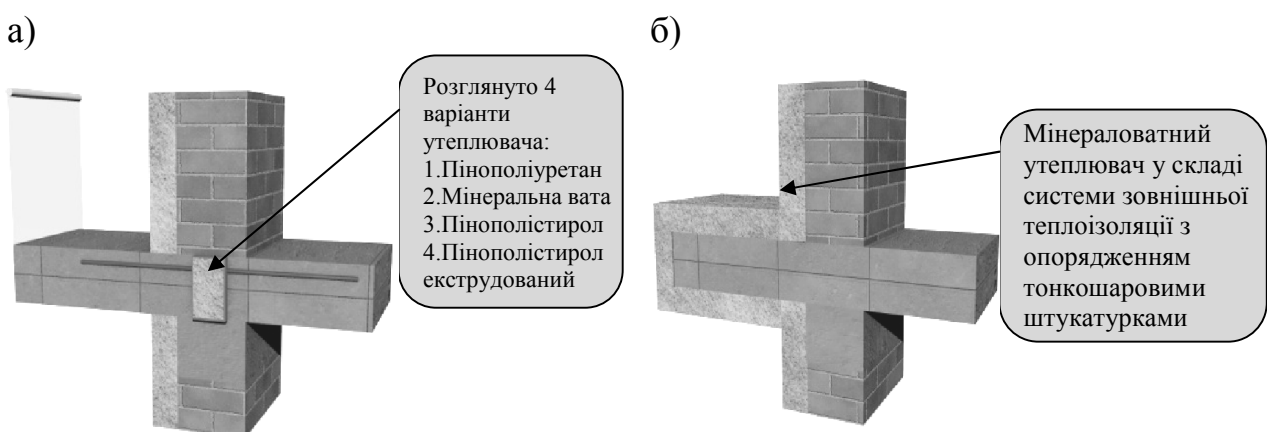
Фрагмент конструктивного поєднання плити балкону та плити перекриття:
